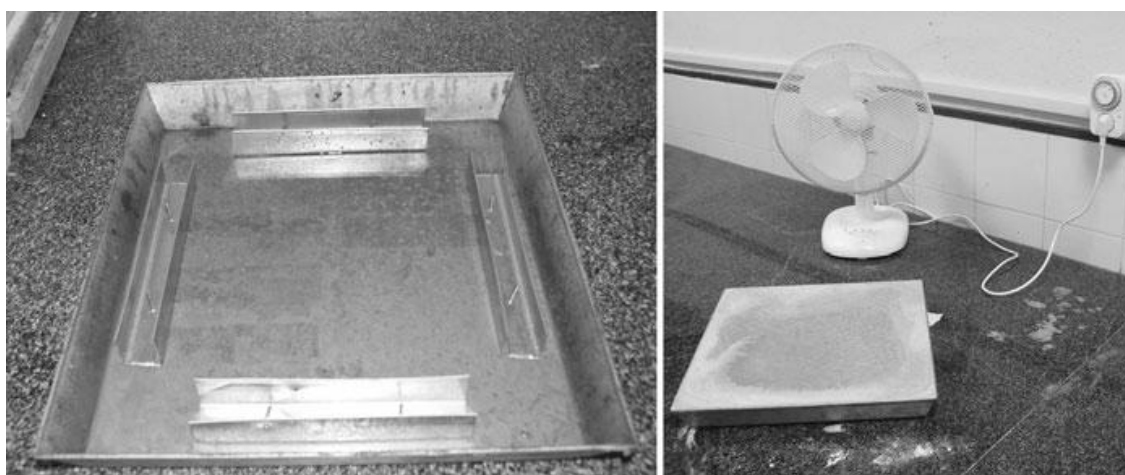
Bandeja de retracción y montaje del ensayo para ensayo de fisuración de pastas.
